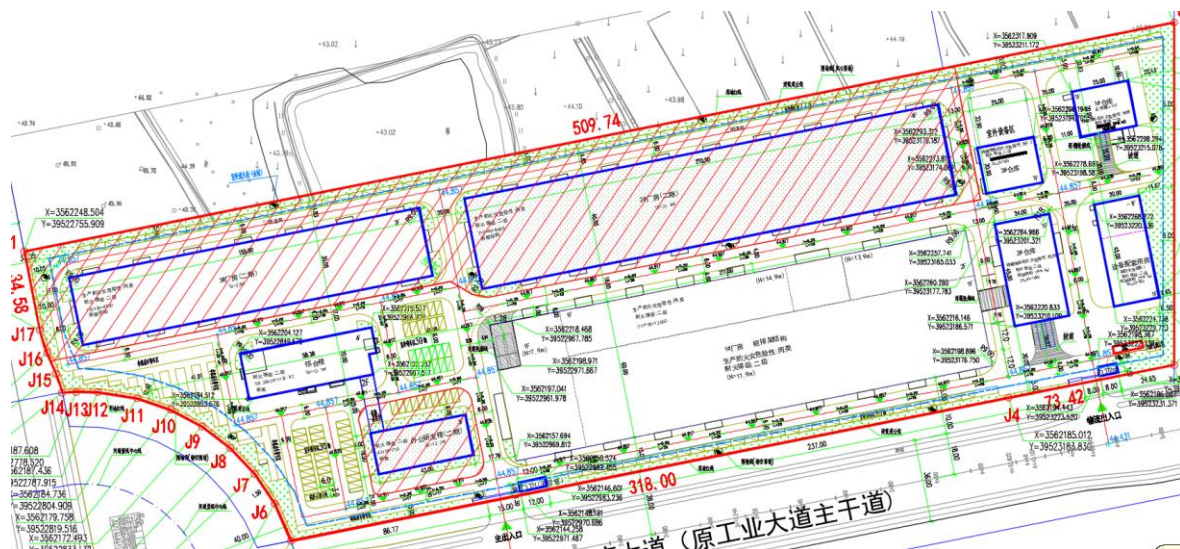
项目平面布置图（红色阴影范围为二期位置）
